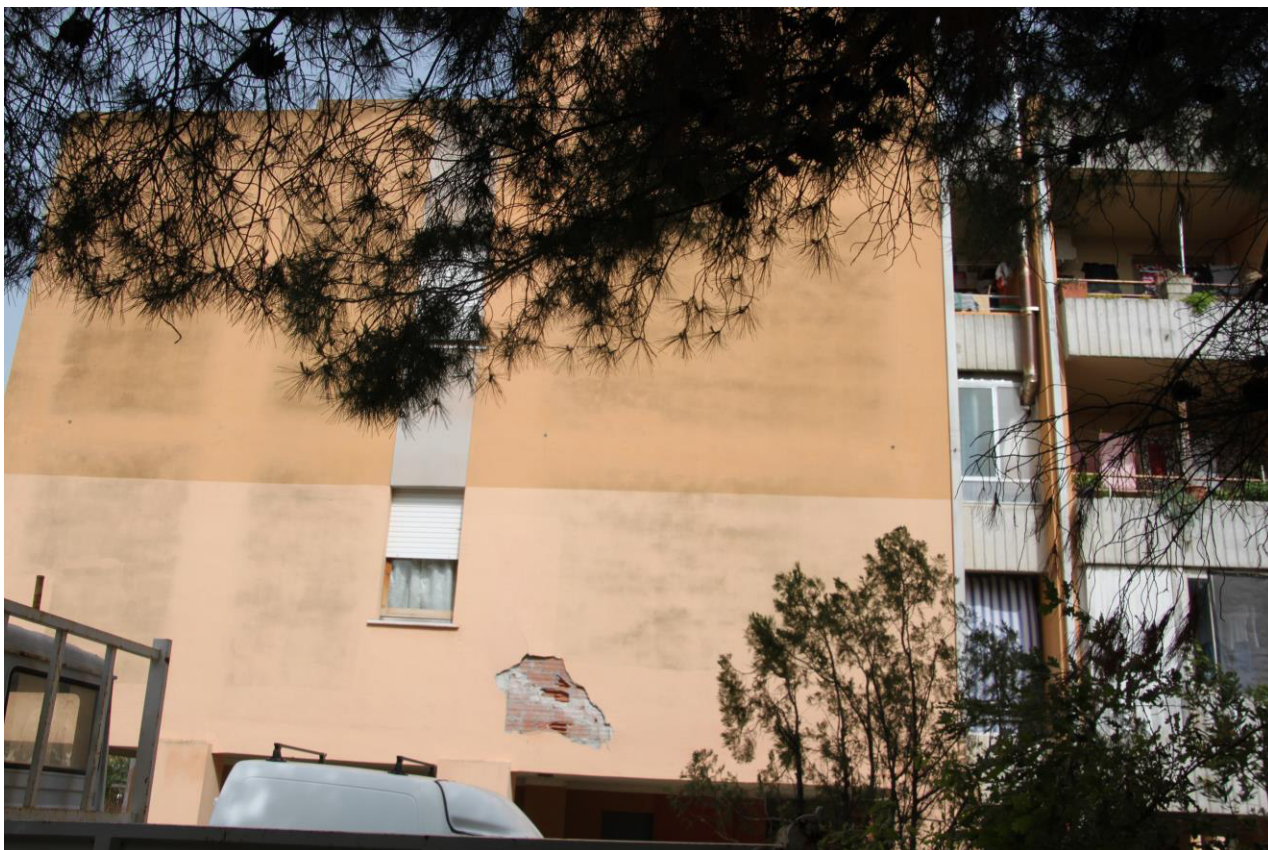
civico 6, vista da ovest con facciata ammalorata
